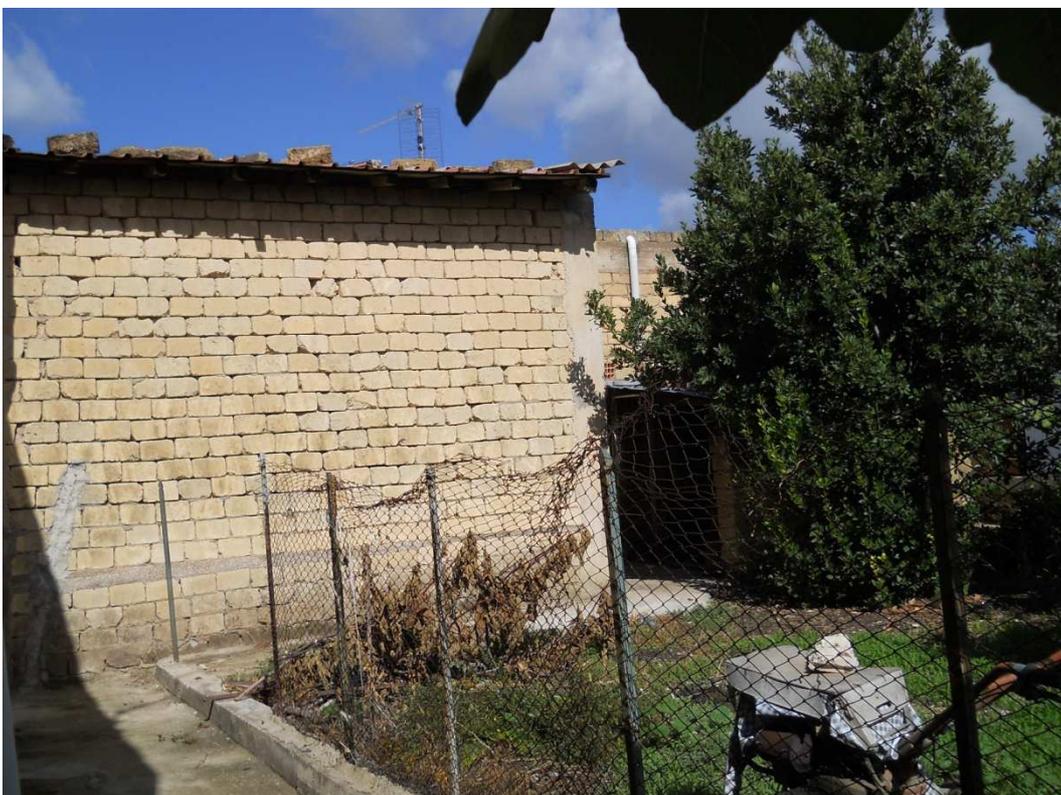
CORPO A – Porzione orientata verso Nord in muratura e tetto a due falde inclinate caratterizzato da travi in legno ed ondulina metallica
